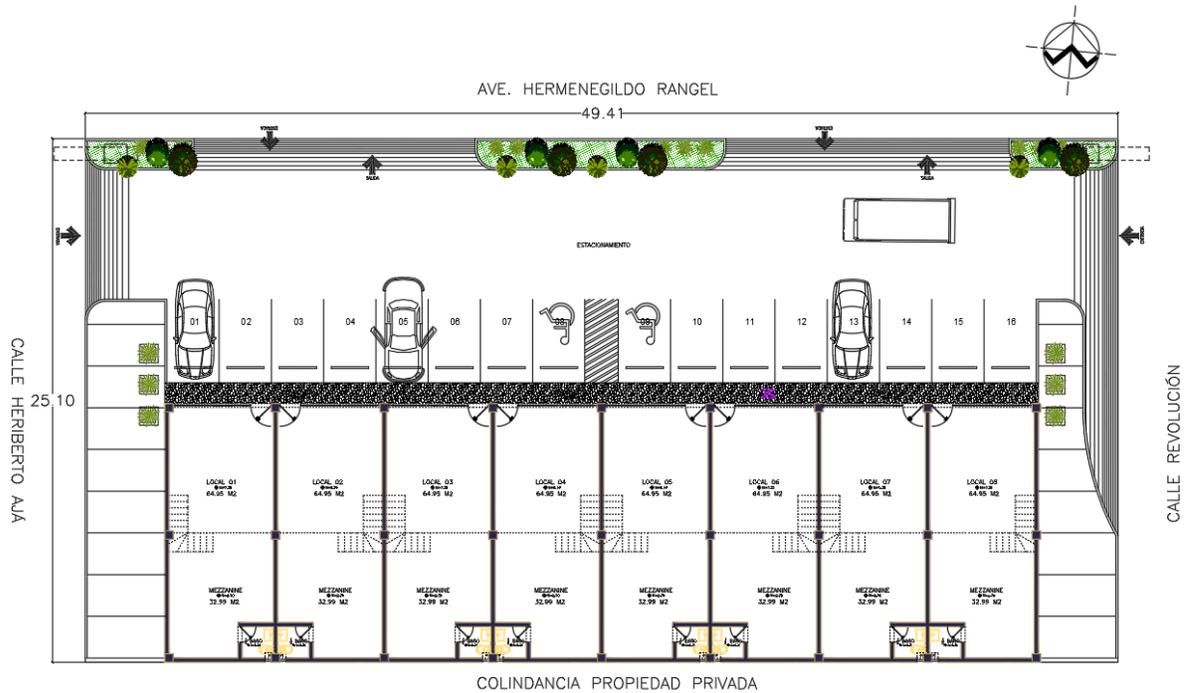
V.49 Planta arquitectónica esquemática de proyecto de Locales Comerciales
